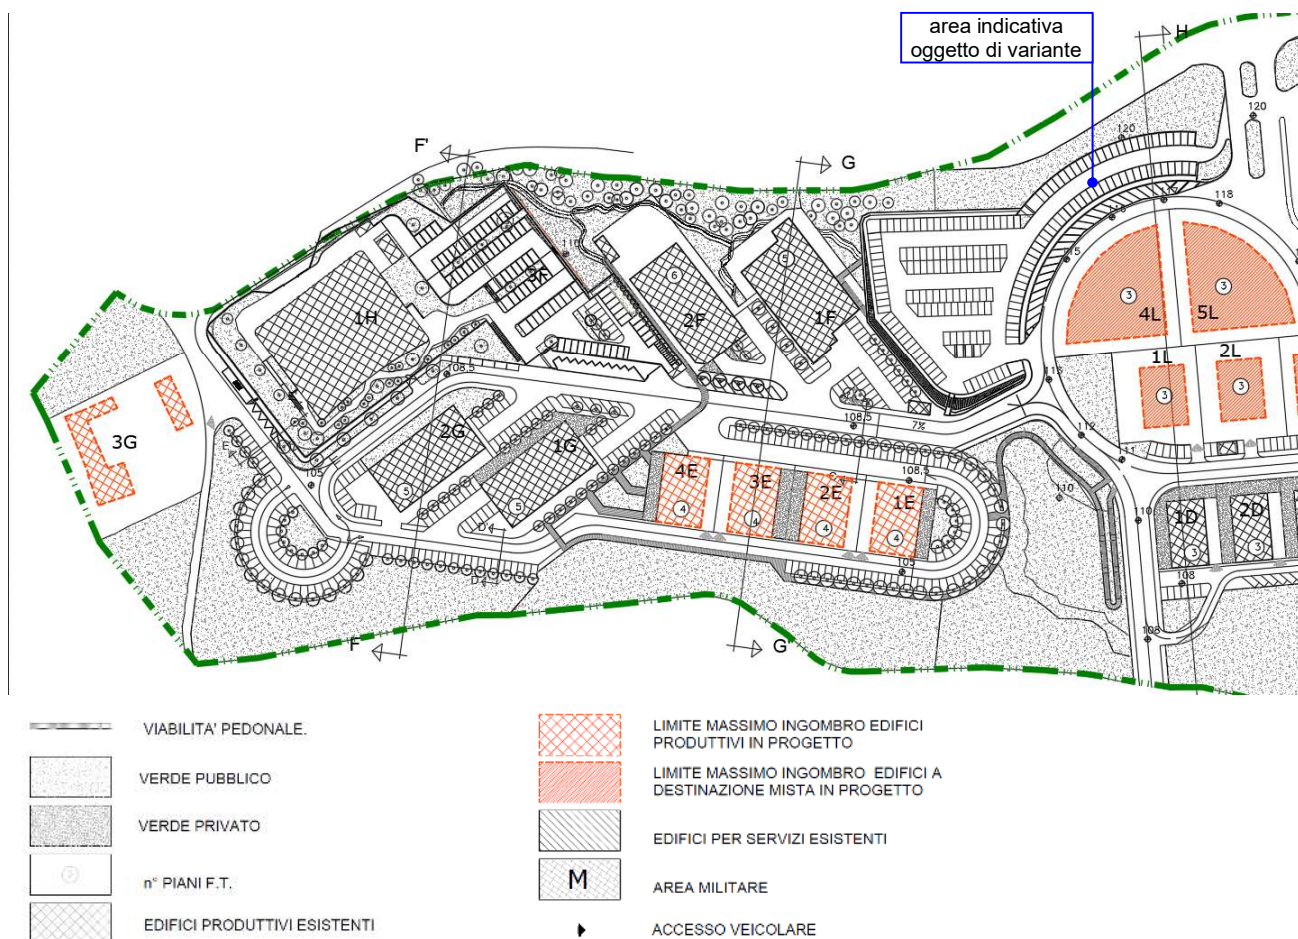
Estratto della Tavola 6 "Planimetria generale di progetto" della proposta di variante di completamento del PP Zona D2
